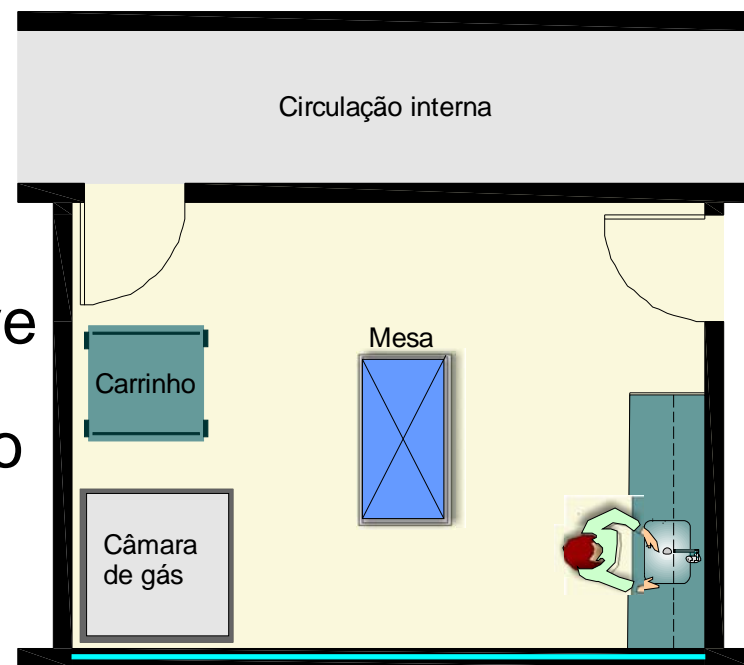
Planta baixa da sala de vacinas (Brasil, 2003).
